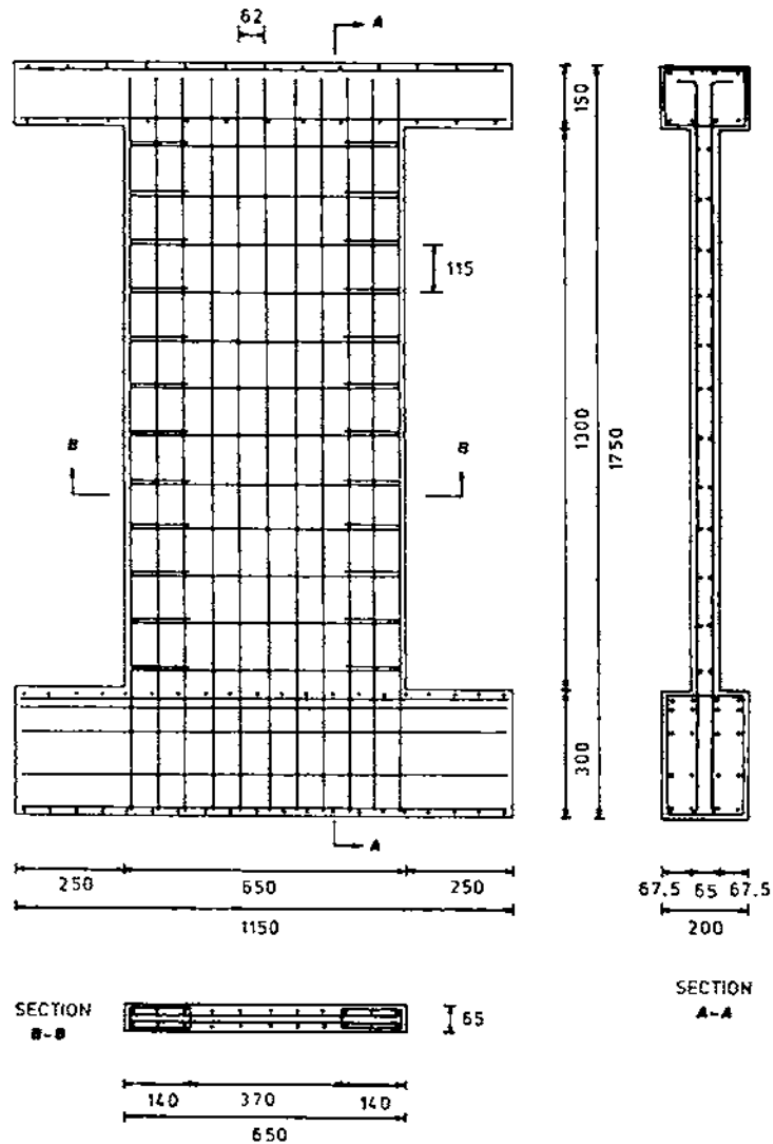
Geometria e armadura de paredes do tipo I (dimensões em mm).
